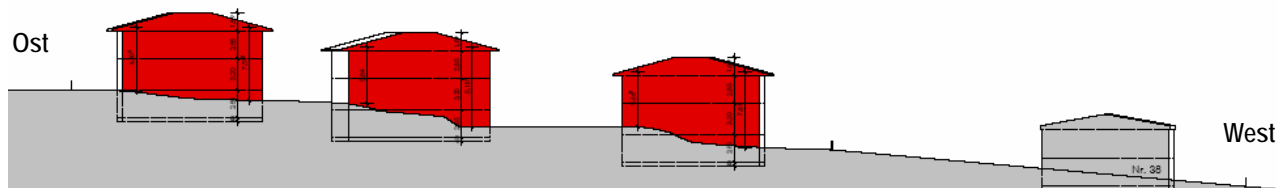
Schnitt durch die im Süden des Geltungsbereichs geplanten Gebäude (Blick von Norden nach Süden; links im Bild: Oppenheimer Straße; rechts: das im Westen an das Plangebiet angrenzende Gebäude)
